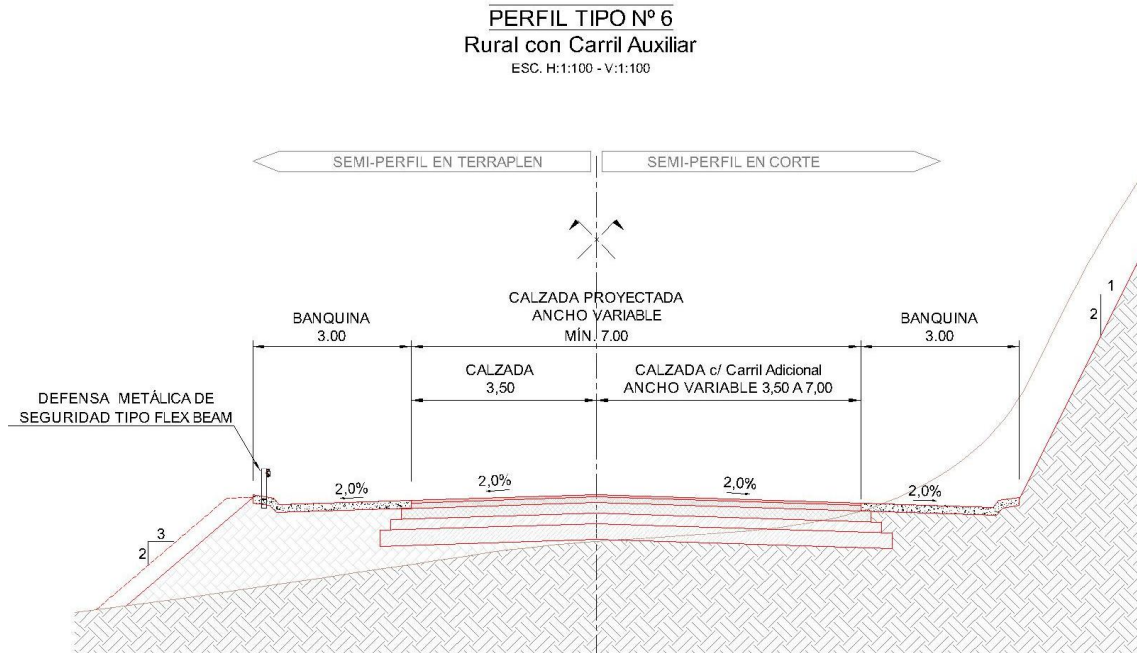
Perfil Tipo con Carril de Adelantamiento.
